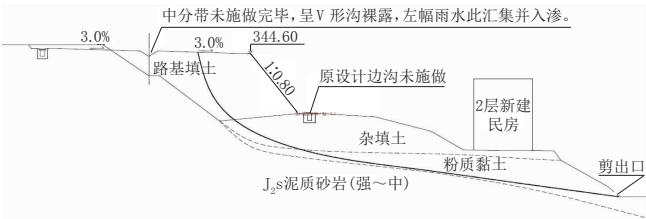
滑坡区典型横断面图(截、排水设施暂未施工)
